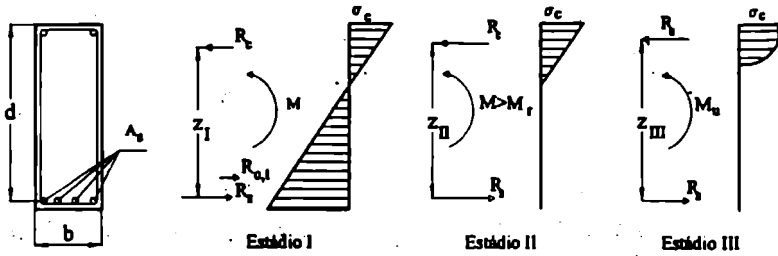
Comportamento da seção transversal de uma viga de concreto armado na flexão normal simples.
